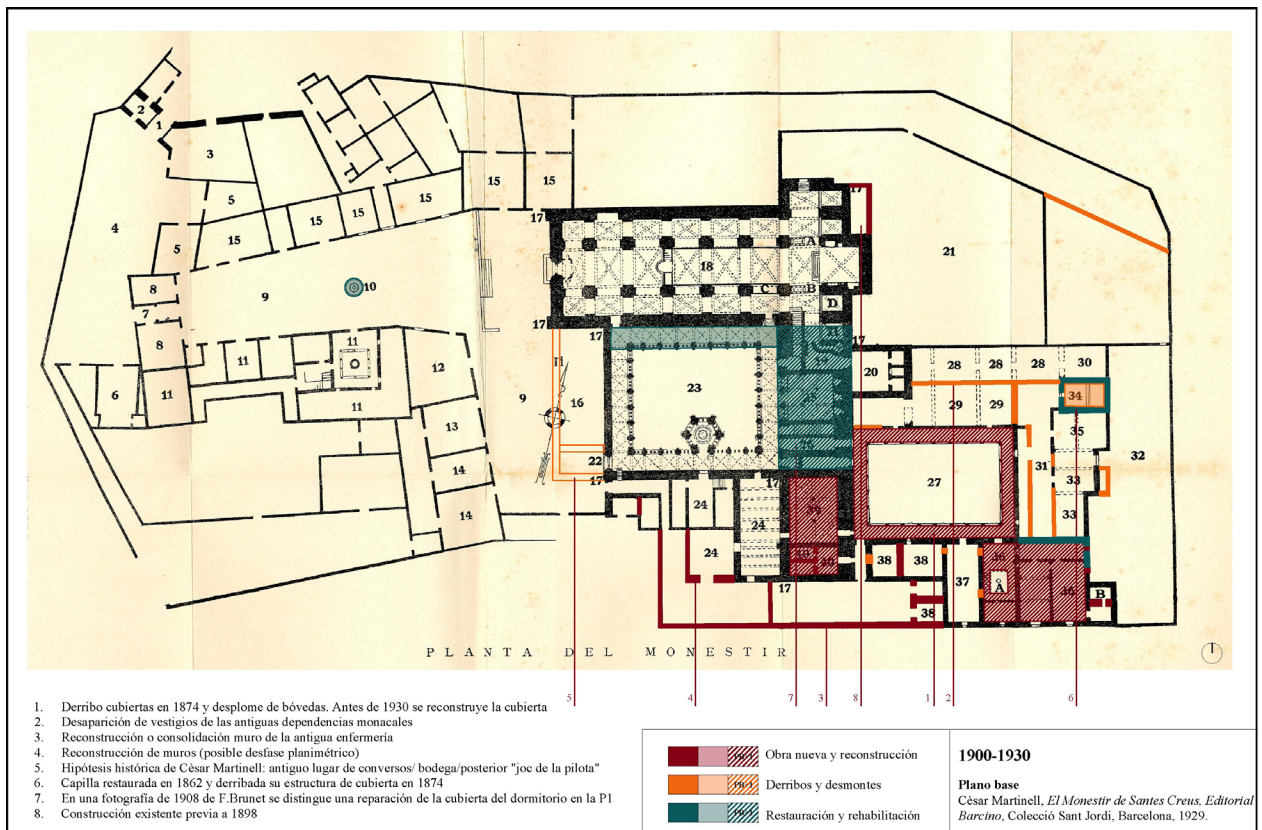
Plano dónde se recogen las intervenciones principales llevadas a cabo entre 1900 y 1930. En rojo se destacan las reconstrucciones, en naranja los derribos, y en turquesa las restauraciones. Elaboración propia.
